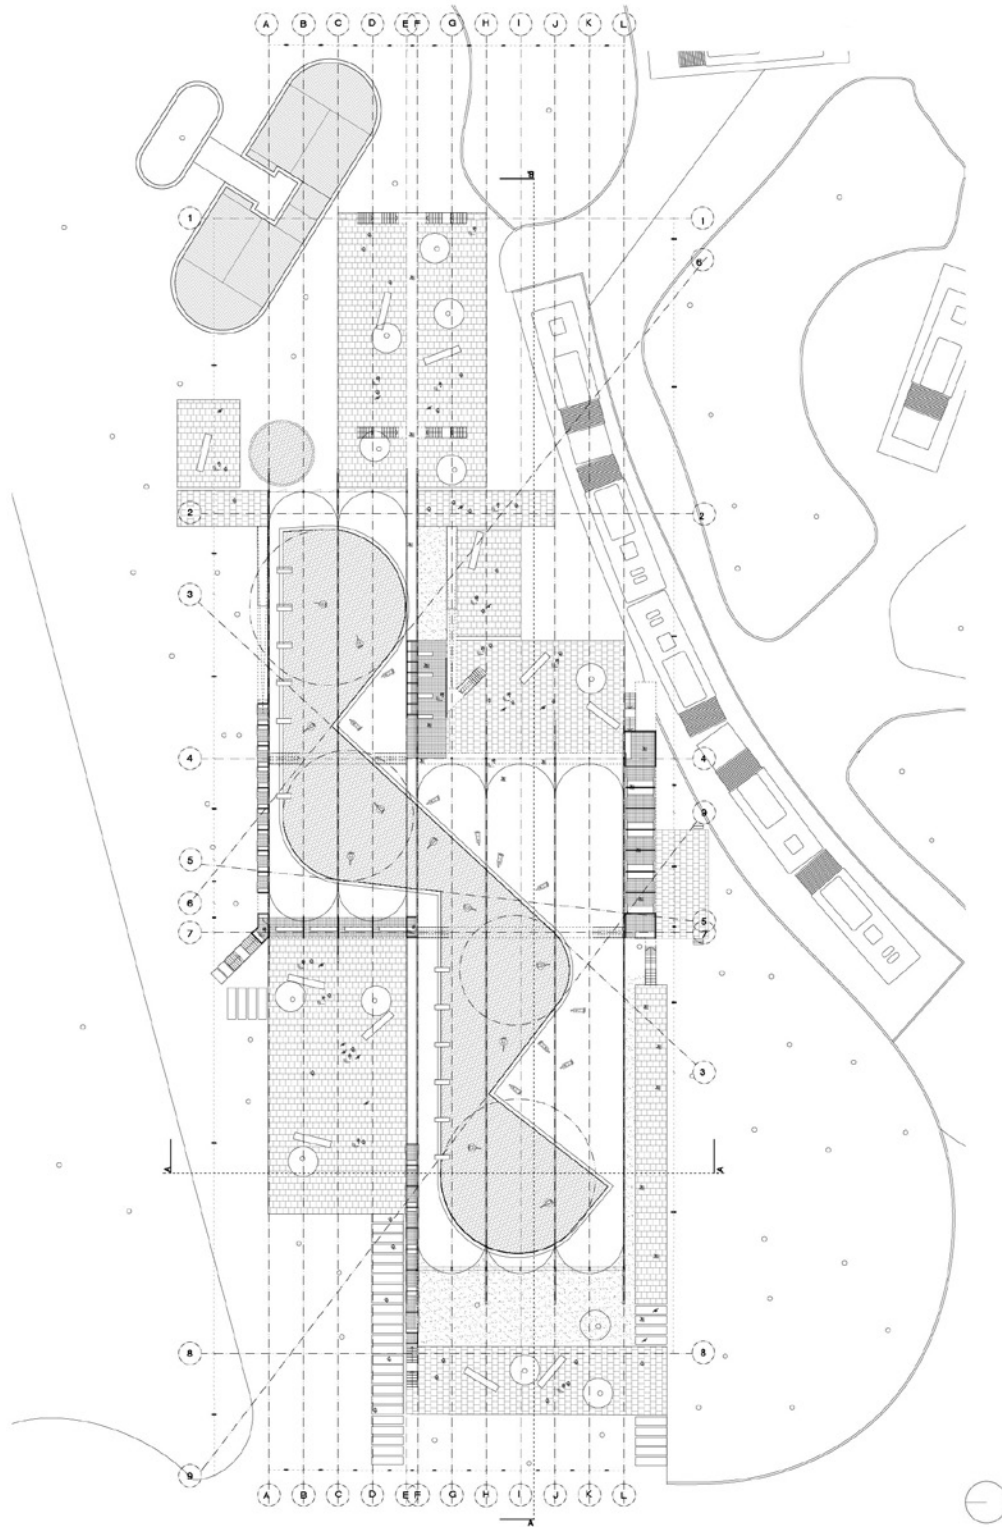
Planta de zócalo de conjunto de baño. Fuente: elaboración propia.
